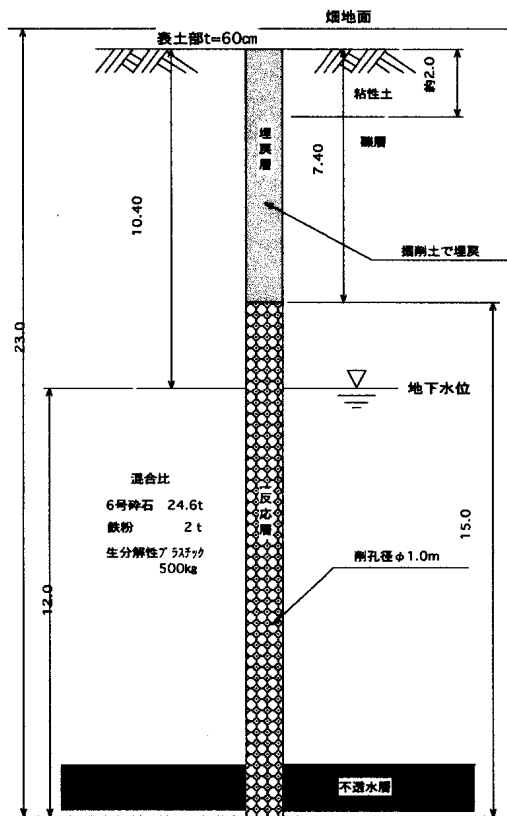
水平方向反応バリアの施工断面図 (単位：m)
